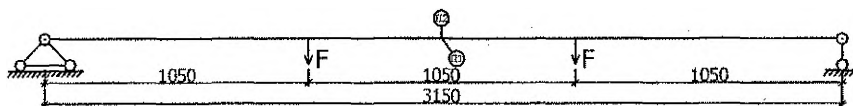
Расчётная схема двутавровой сварной балки, нагруженной по нижнему поясу.
